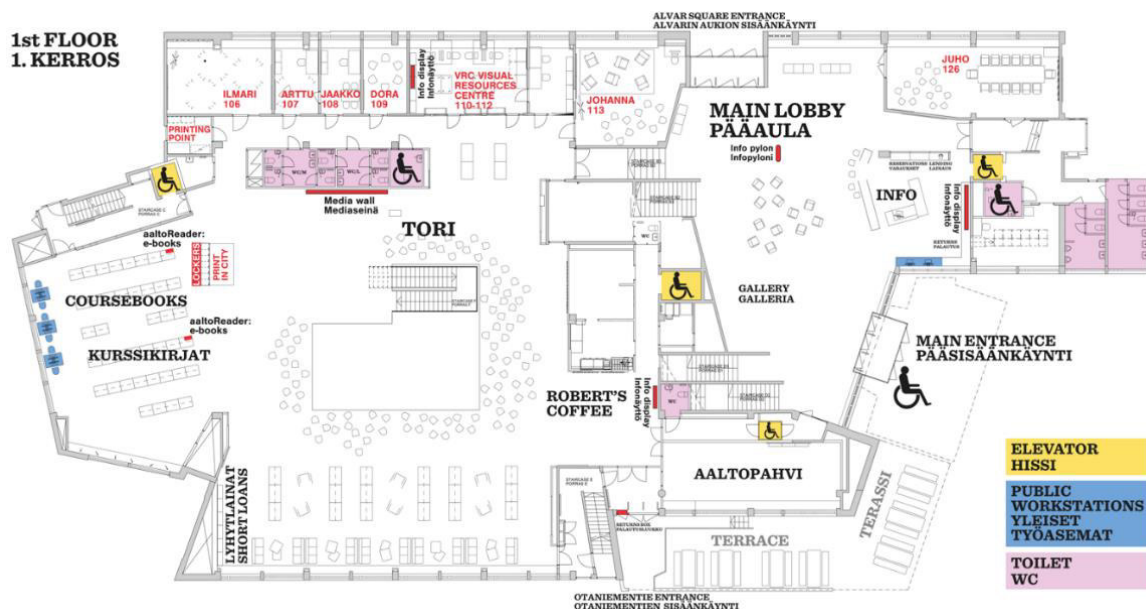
HHLC Grundriss Erdgeschoss (1. Floor). Quelle: http://web.lib.aalto.fi/c/web/img/lc_img/1KRS_web_iso.png (11.06.2020)
